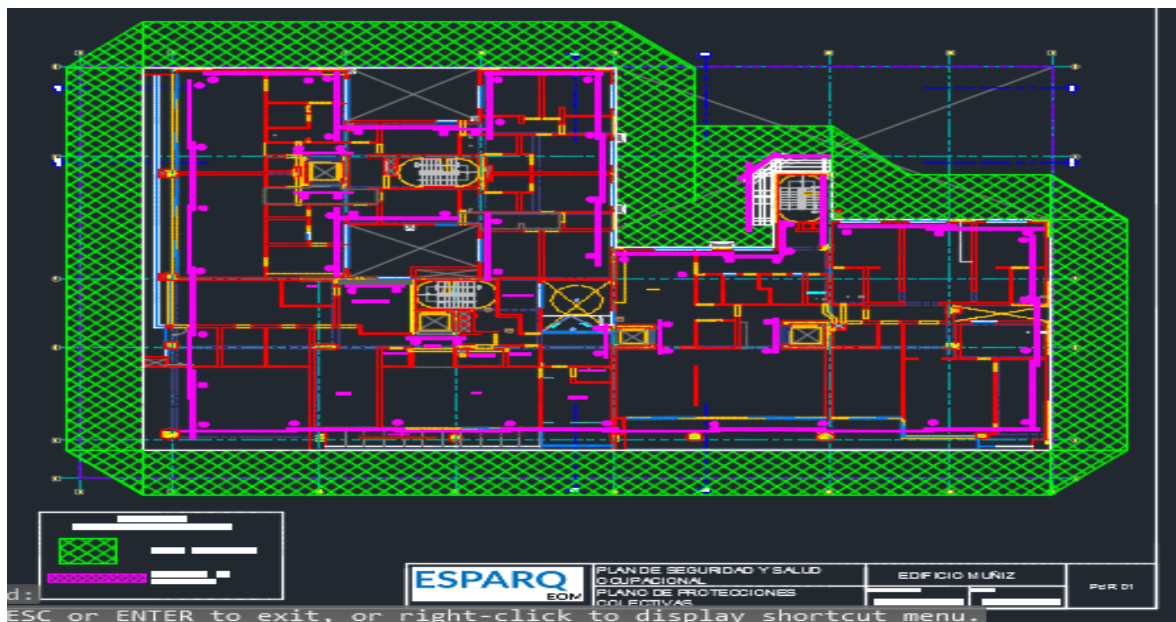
Plano de Protecciones Colectivas externas de obra.
